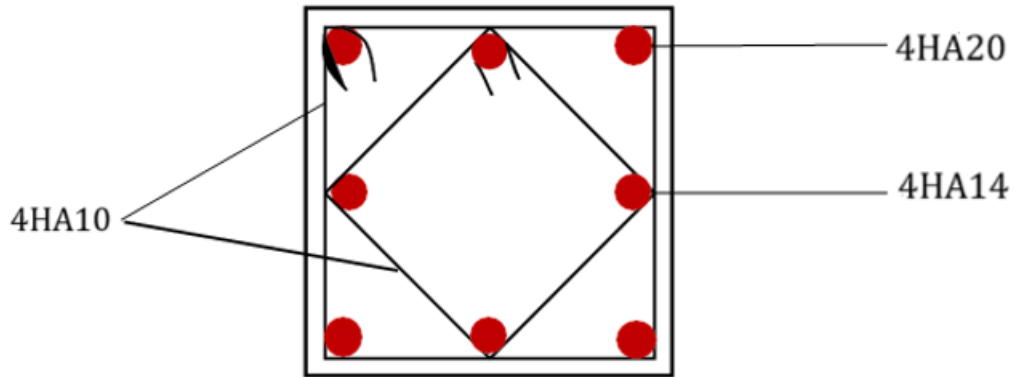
Schéma de ferrailage des poteaux 45×45.
